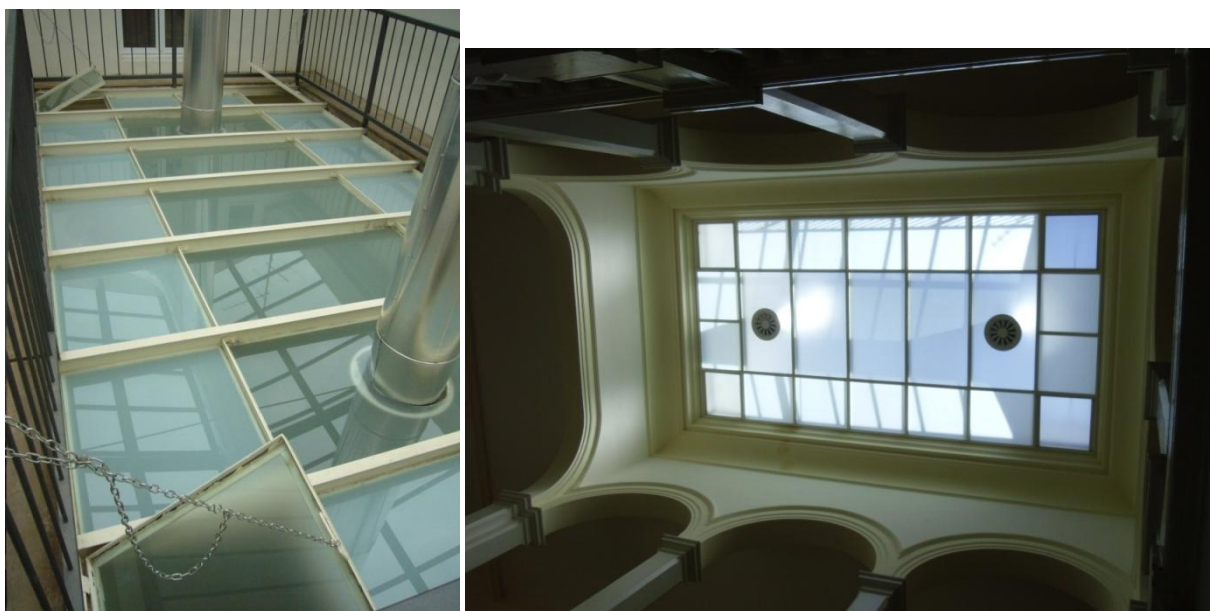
Foto del lucernario inferiore, rispettivamente dall'alto e dal basso
